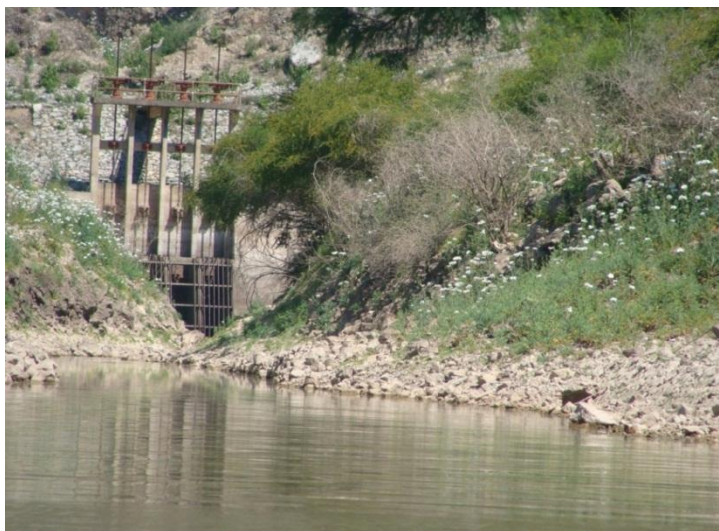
Túnel ubicado en el cerro de El Tajo. Fuente: Foto Carmen López
